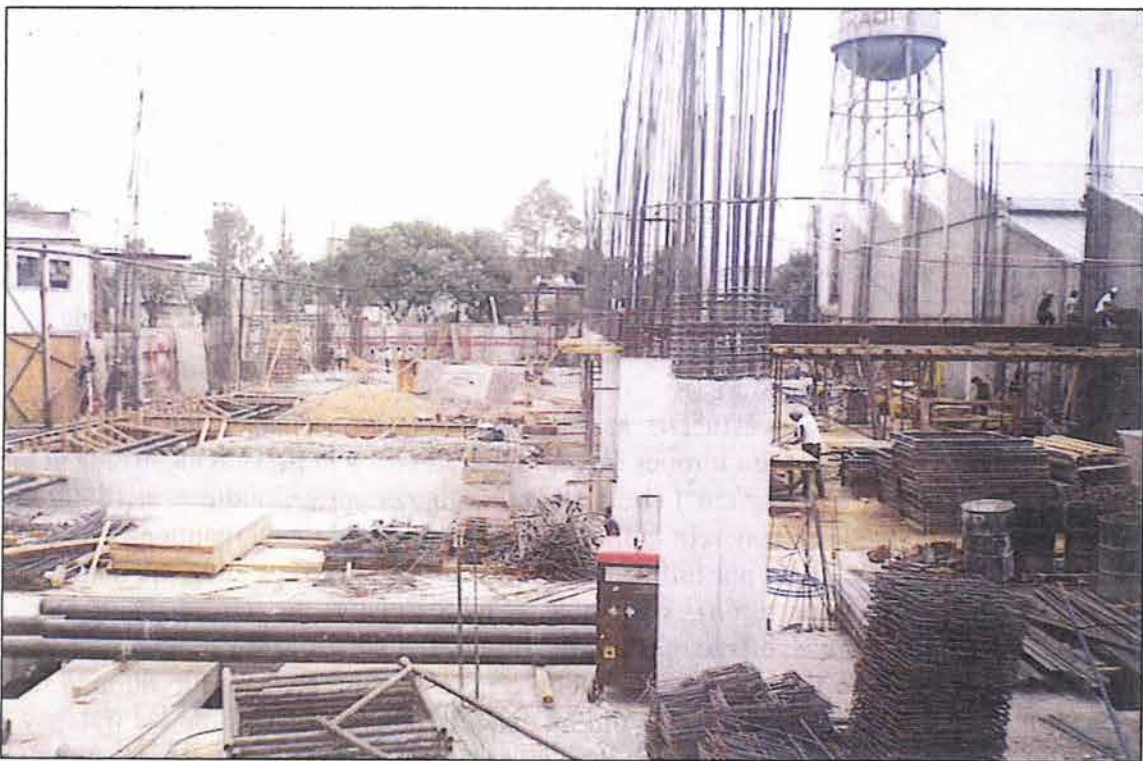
Avance de los trabajos para la cimentación y columnas de planta baja. Inicio de la colocación de la cimbra para trabes y losas de primer piso.
